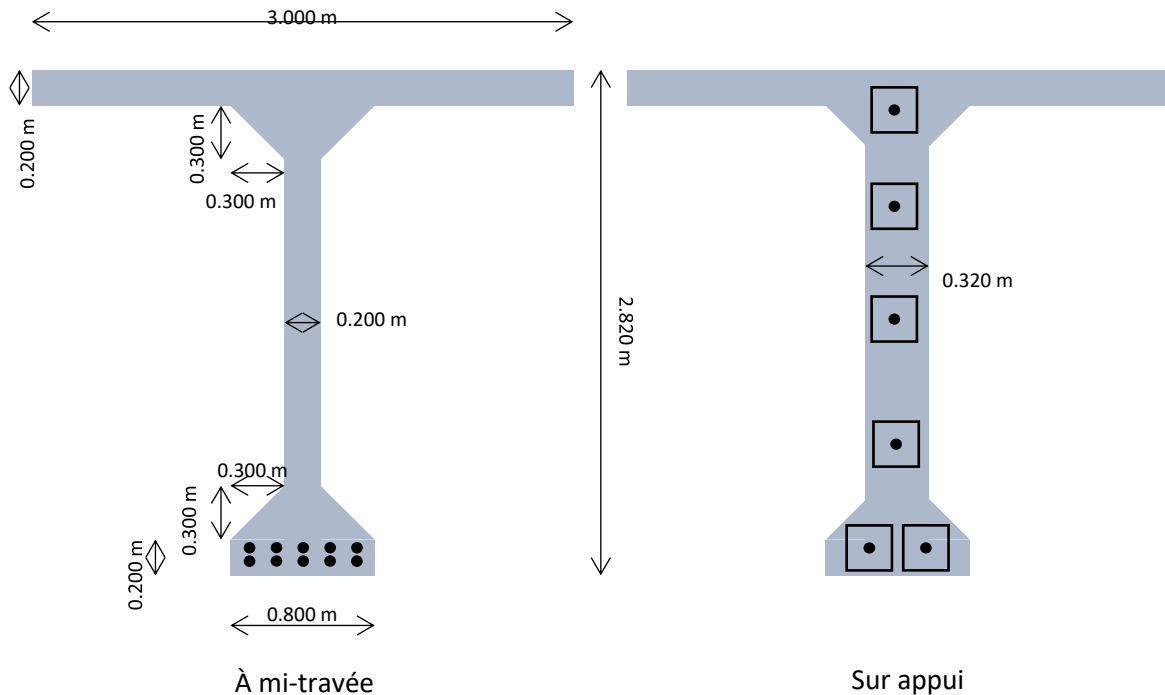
COUPE TRANSVERSALE A MI-TRAVEE ET SUR APPUI DE LA POUTRE C
